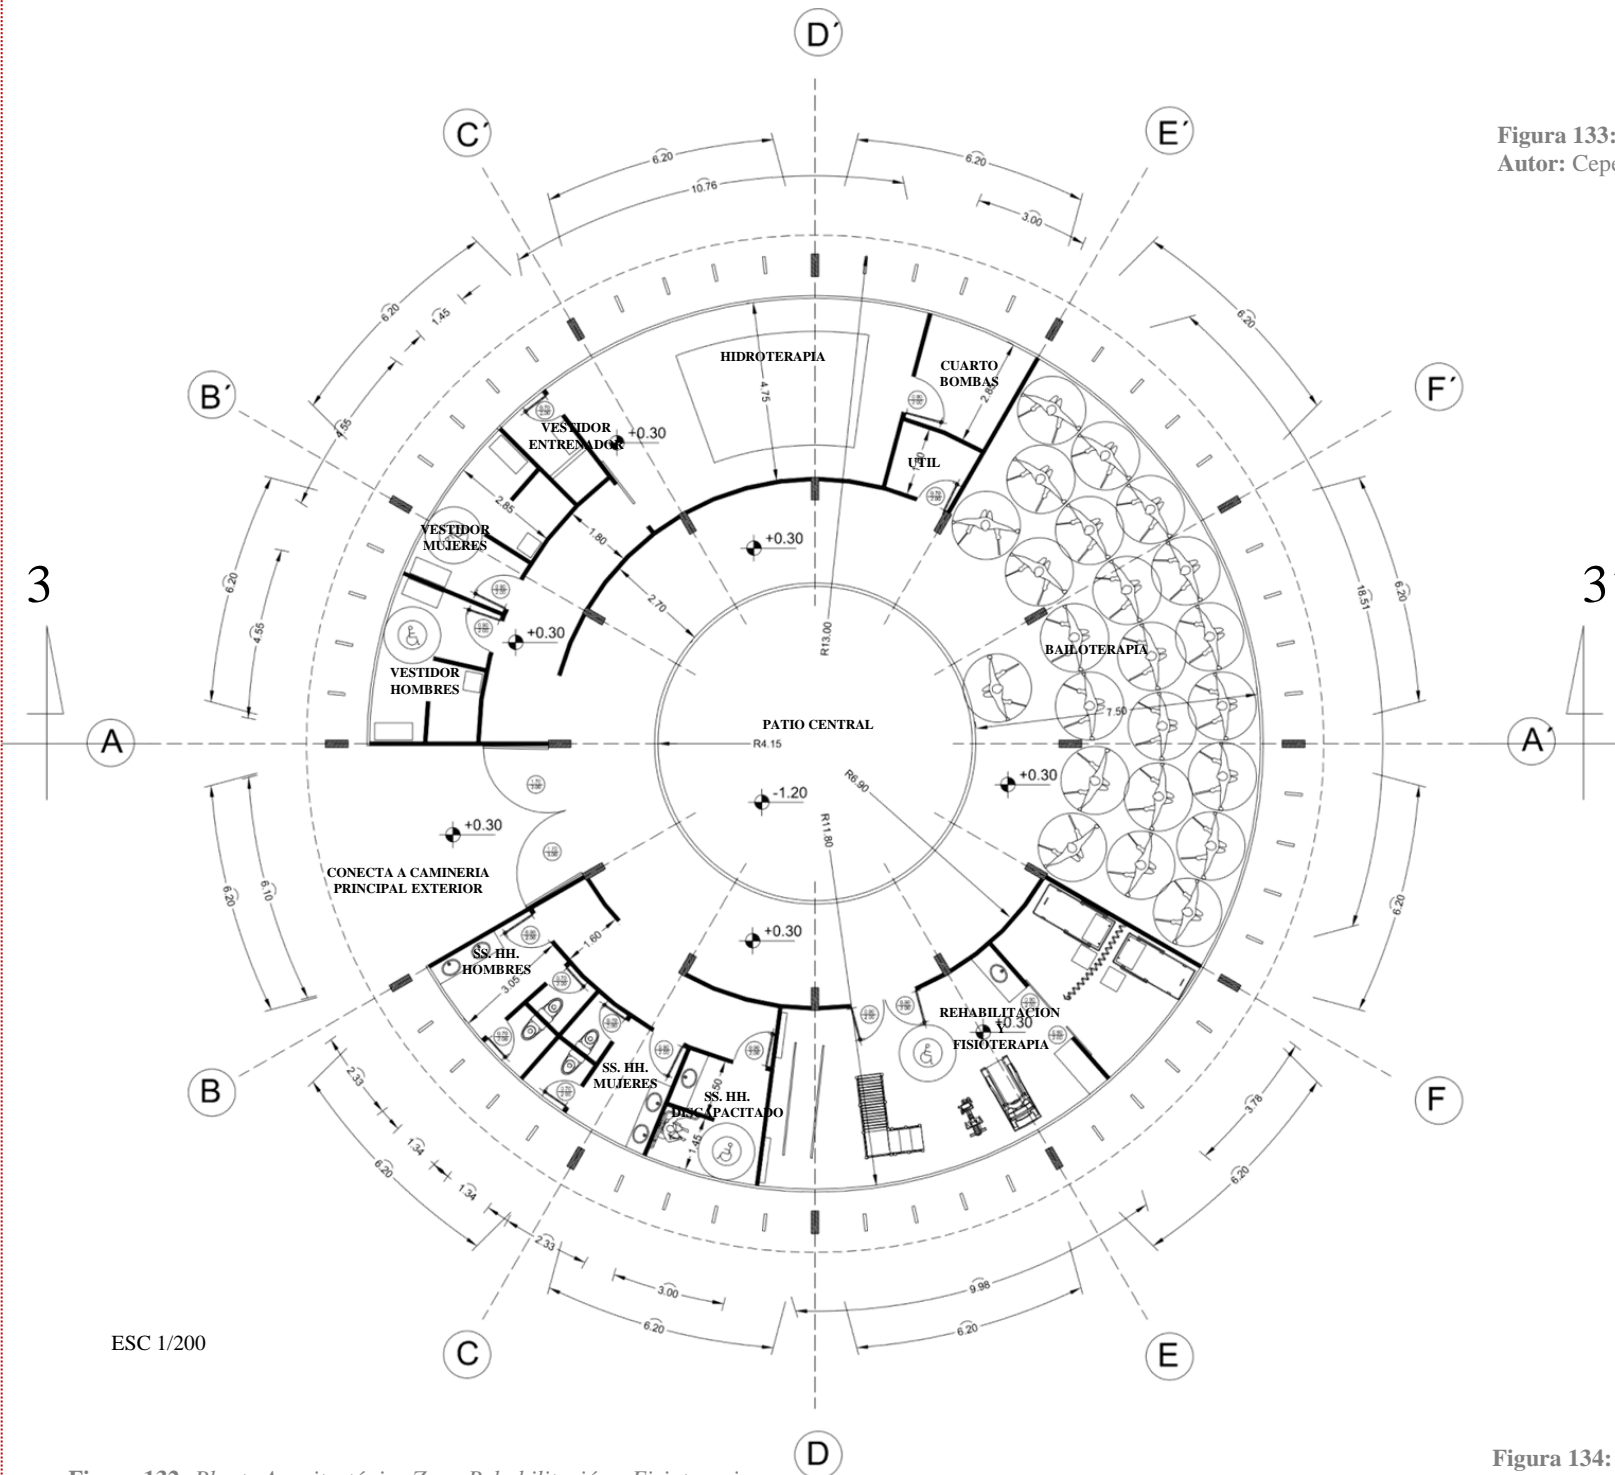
Planta Arquitectónica Zona Rehabilitación y Fisioterapia
